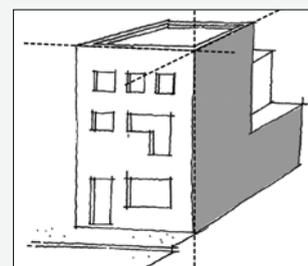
B : intersection du plan de façade et du plan de toiture – cas d'une construction avec toiture plate.
